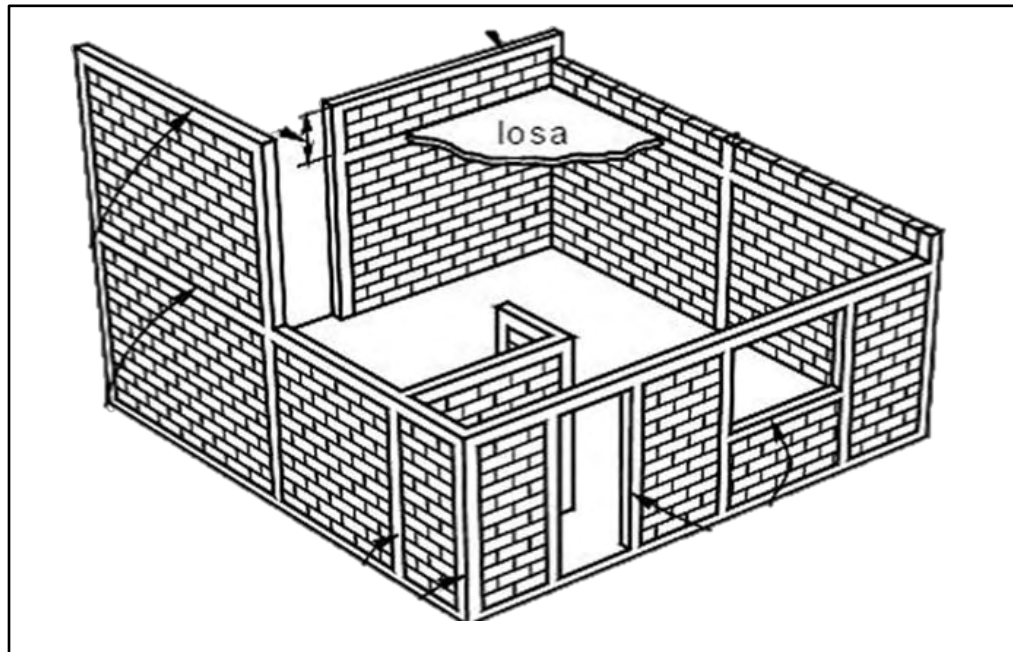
Ilustración especificaciones de un muro en mampostería, NSR-10
